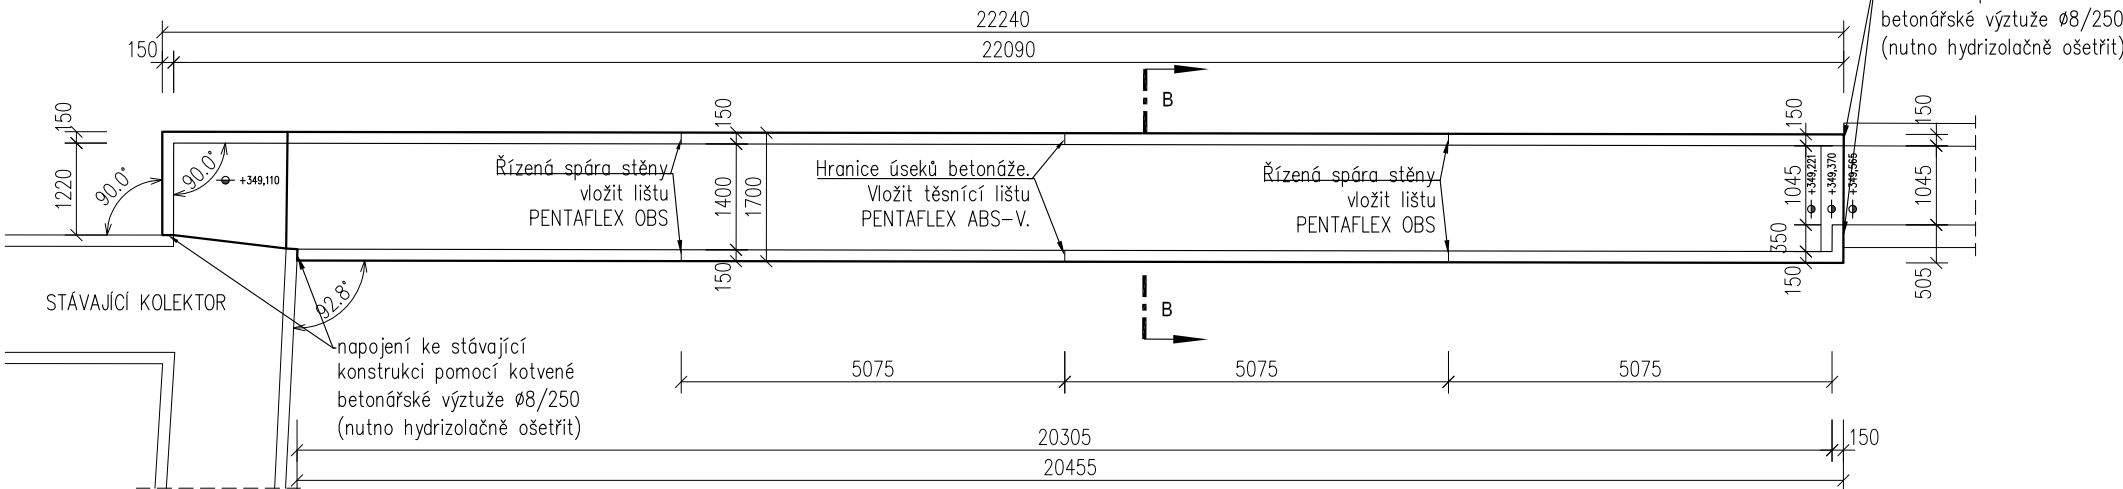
DETAIL HRANICE ÚSEKU BETONÁŽE OBVODOVÉ STĚNY
